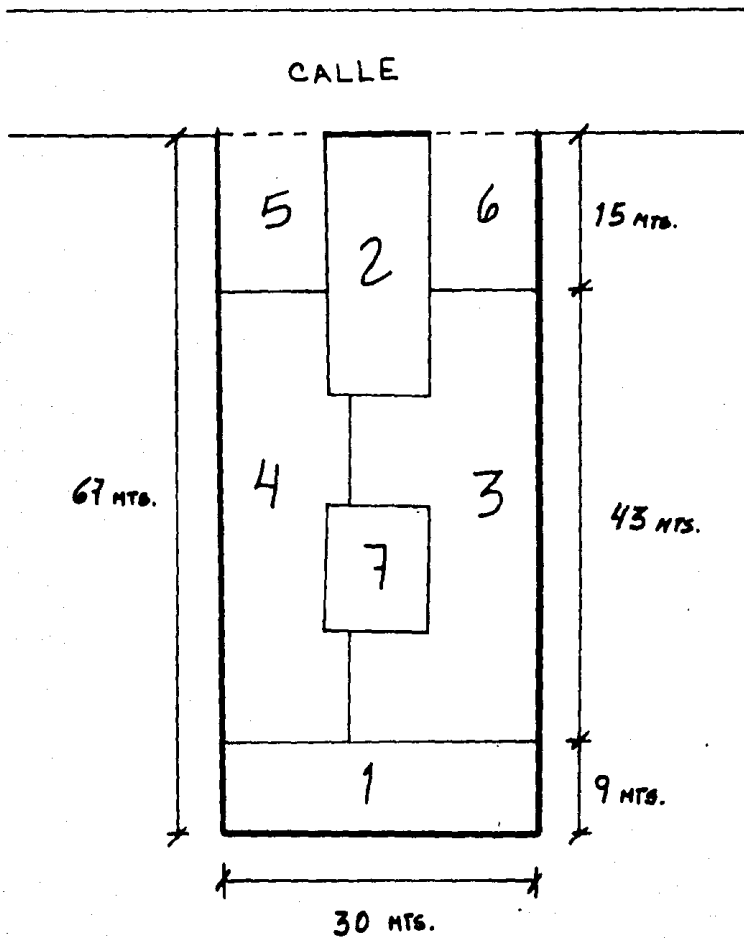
DISTRIBUCION DE LA PLANTA.
